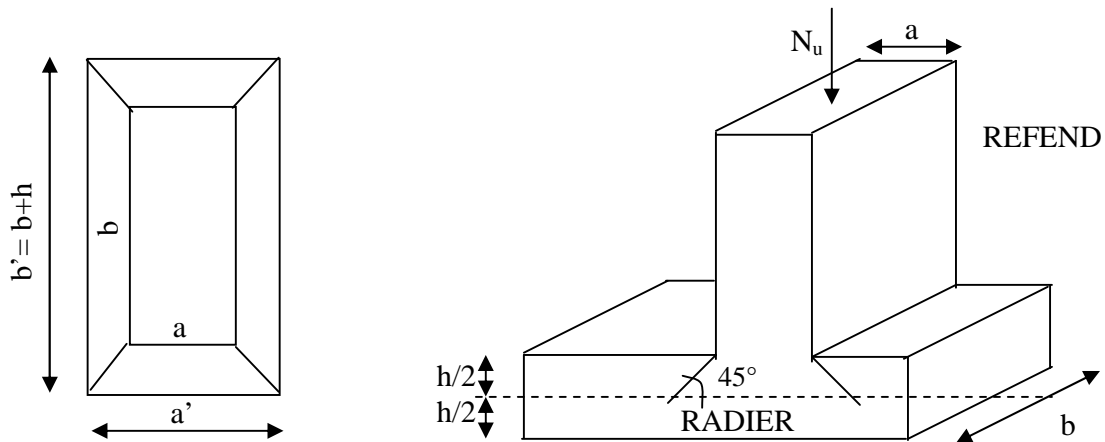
Périmètre utile des voiles et des poteaux.
